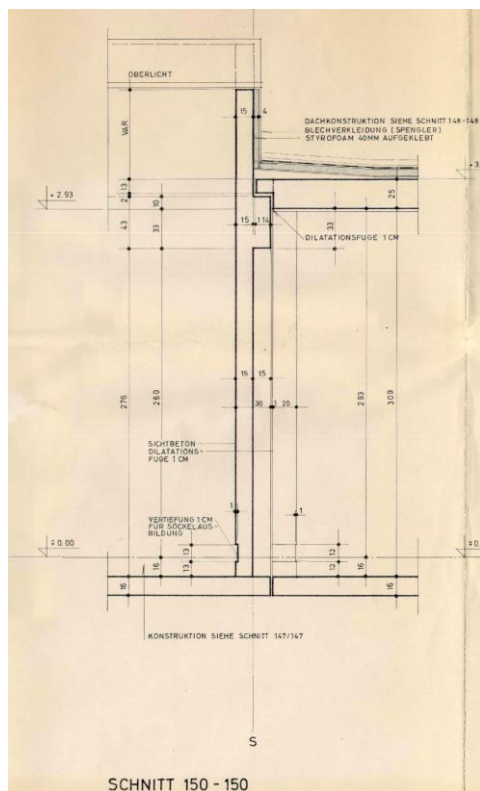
Schnitt 150 durch Decke über UG und EG (Lage siehe Bild 99), Planausschnitt Plan Nr. 147-154, E. Ulrich, 1972
